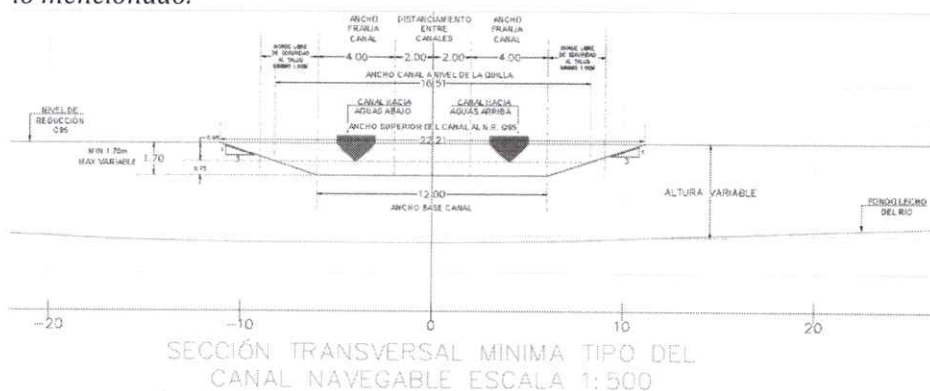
Sección transversal mínima del canal navegable proyectado para el río San Juan.
